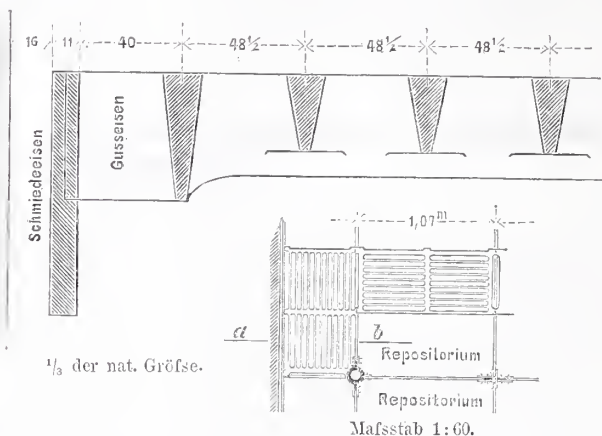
Schnitt durch eine eiserne Fußbodenplatte und Grundriss des eisernen Fußbodens.
